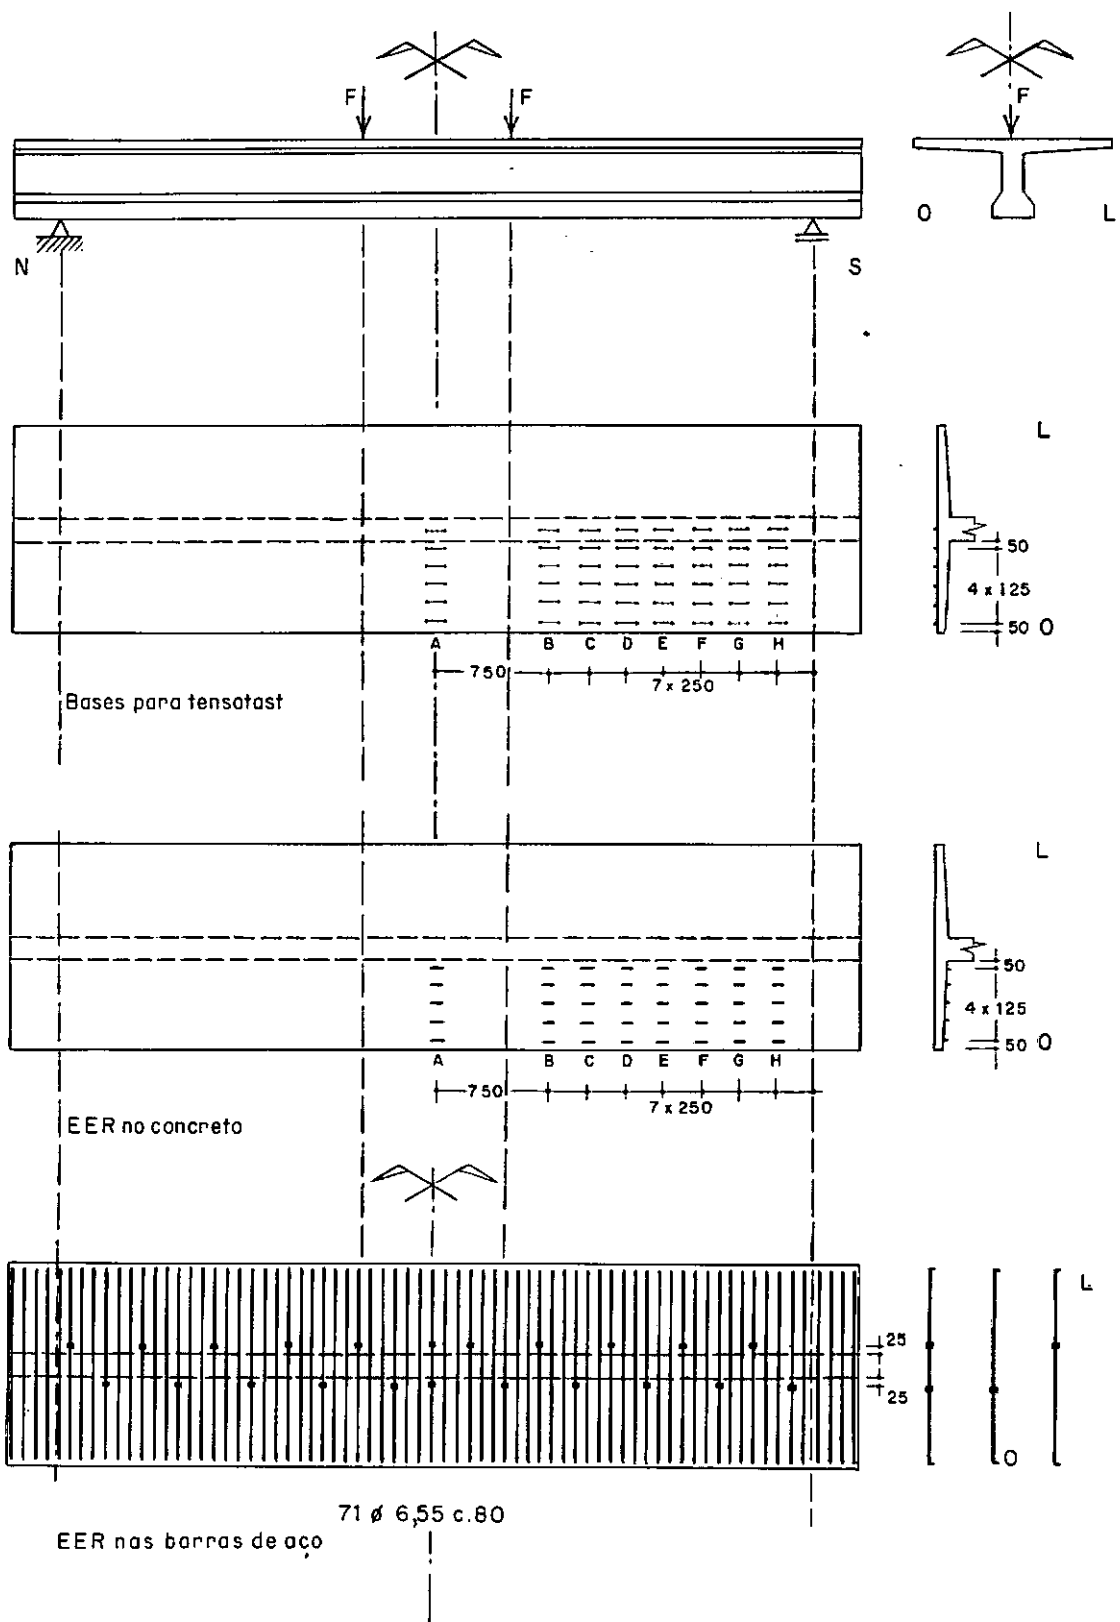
c - Instrumentação da viga T3 - (cotas em mm)
